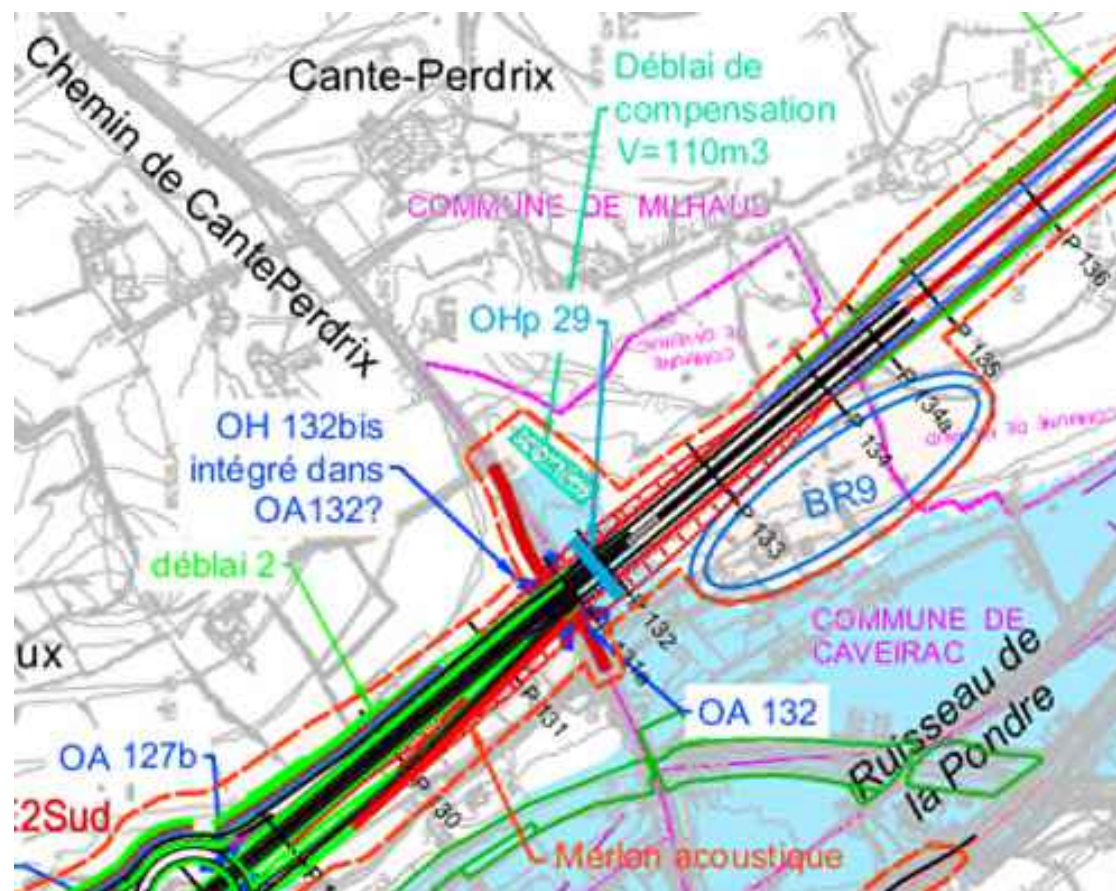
Localisation des ouvrages sur le secteur de Canteperdrix
